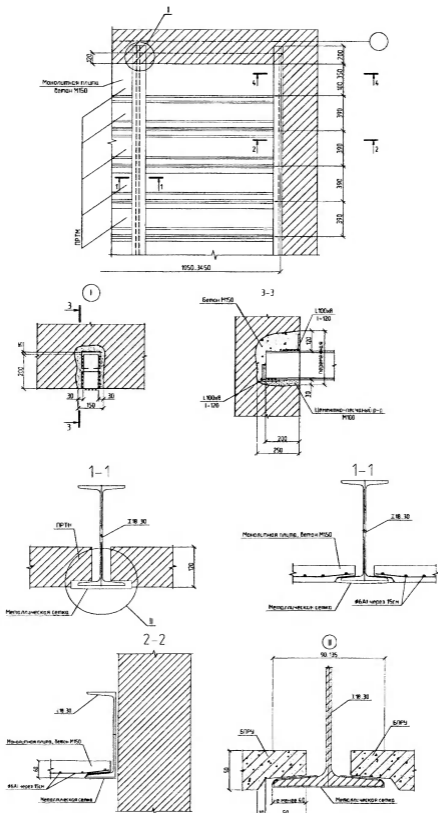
Примеры устройства междуэтажного перекрытия по металлическим балкам
